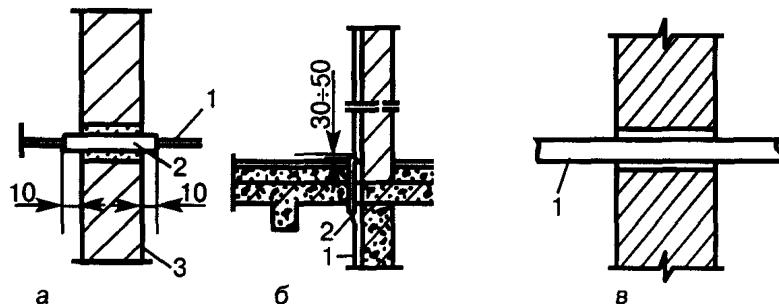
Проходы заземляющего проводника сквозь стену (а), через перекрытие (б), в открытом проеме (в):
